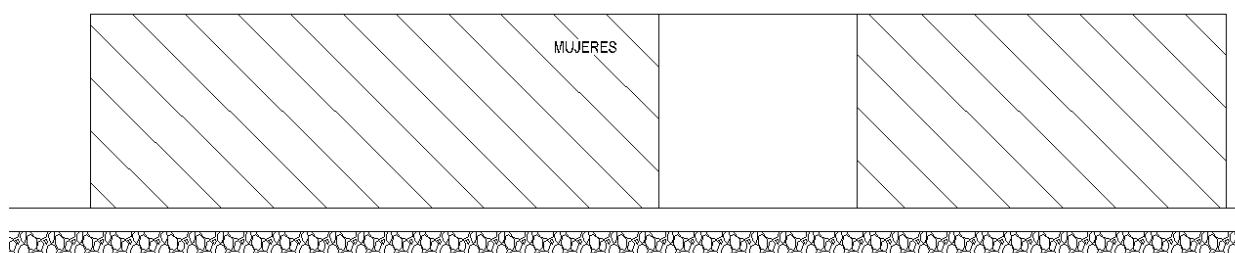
Fachada Frontal Izquierda Aulas/talleres
